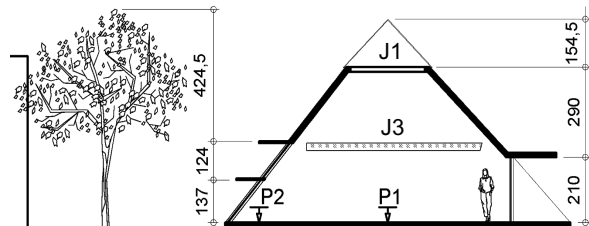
Corte Longitudinal da edificação proposta. Fonte: Elaborado pelos autores.
